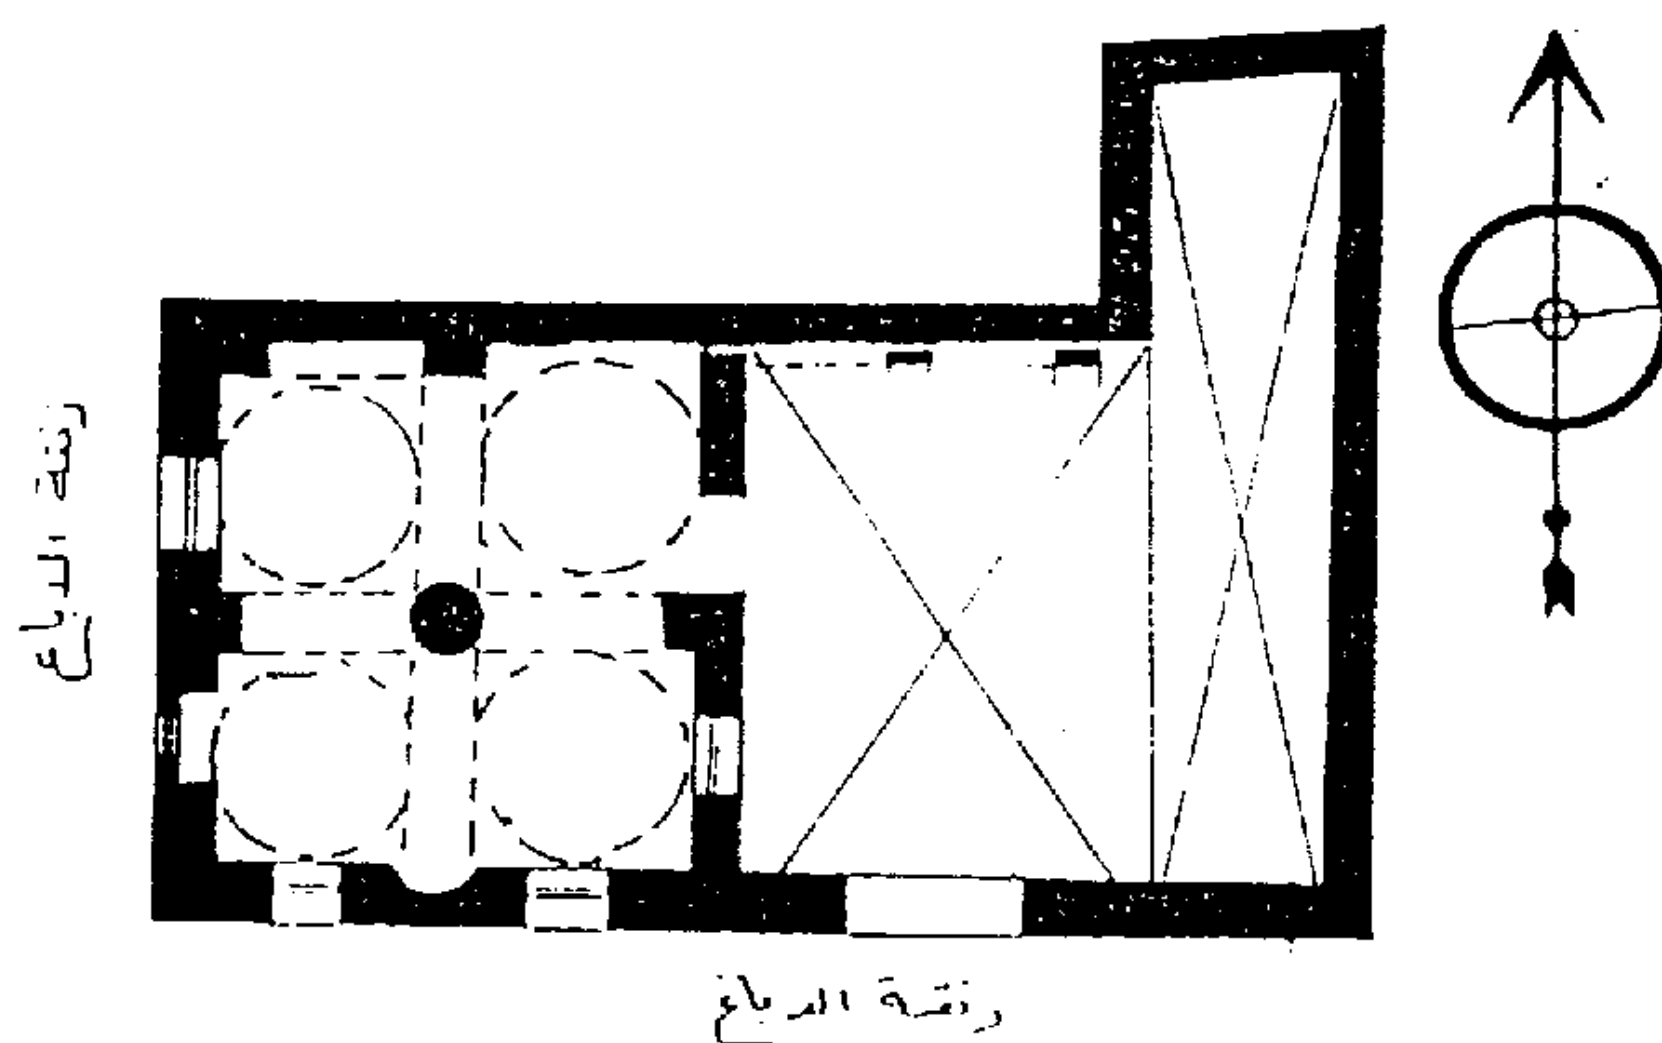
مسقط أفقي لمسجد كولوك عن أصلان آبا.
